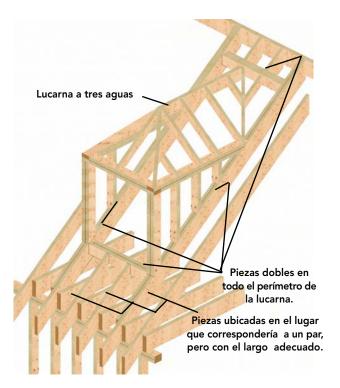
Lucarna a tres aguas que interrumpe los elementos estructurales del diafragma inclinado y que requiere de refuerzos en el perímetro donde se recortaron las piezas de la estructura de techumbre.
